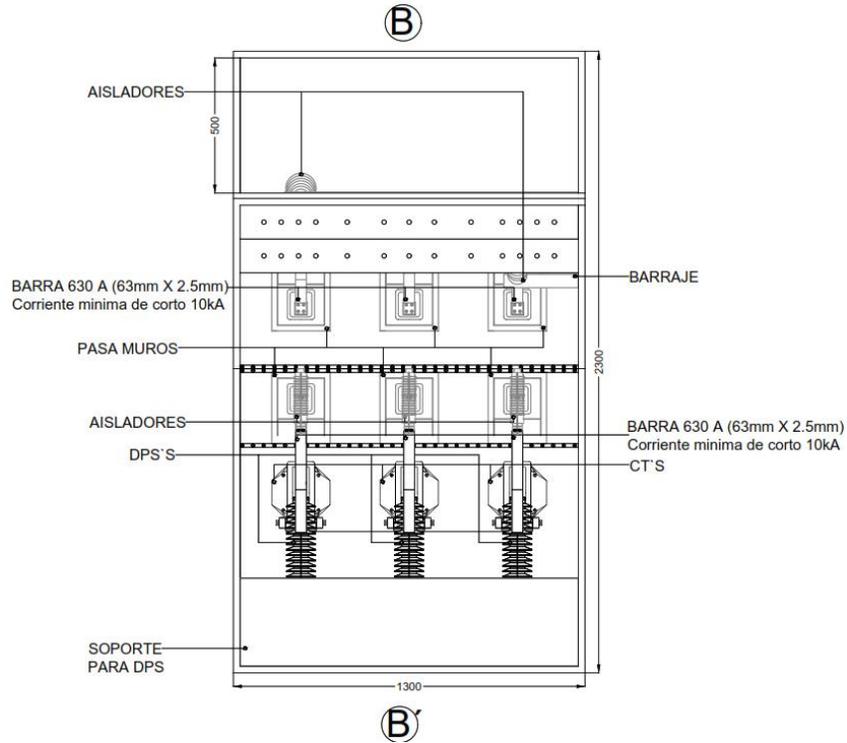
Plano mecánico de celda de conexión – vista posterior interna corte B-B’.
